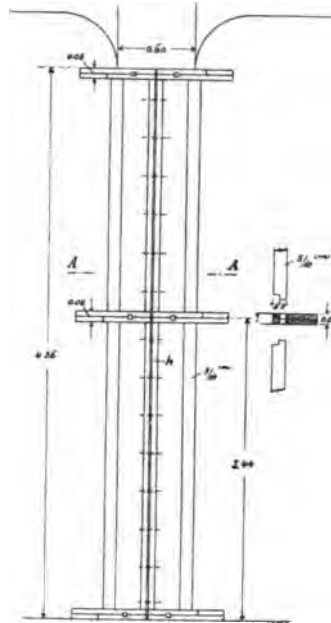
Verschalung einer runden Säule. Schalmantel aus einem Blechzylinder bestehend.
